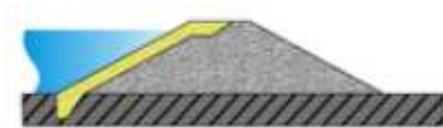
Schema trasversale di una diga in terra e/o pietrame con struttura di tenuta esterna
